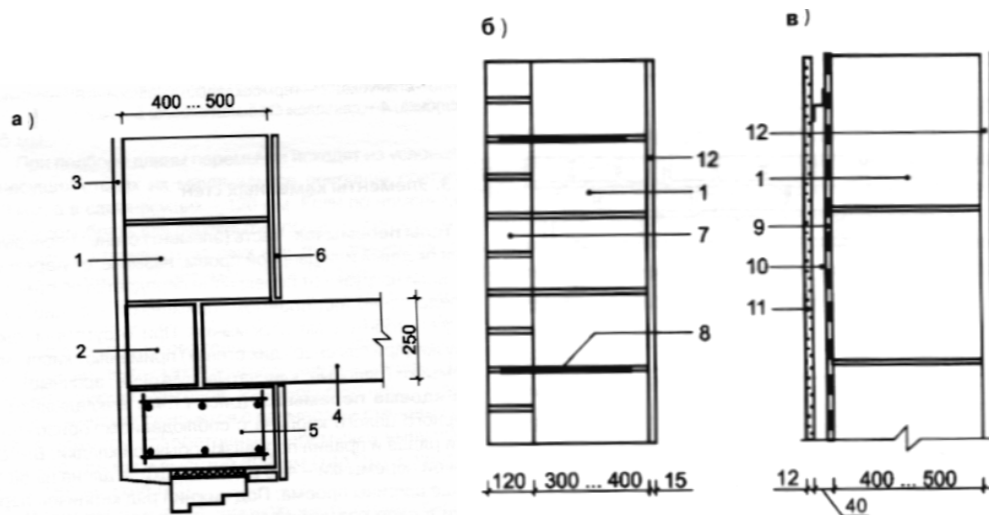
Наружные стены из полистиролбетонных блоков:
